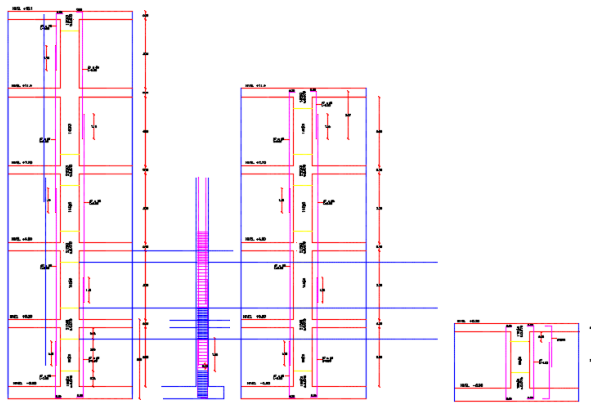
ALZADA DE COLUMNAS Y PANTALLAS DE LOS DIFERENTES PISOS.
